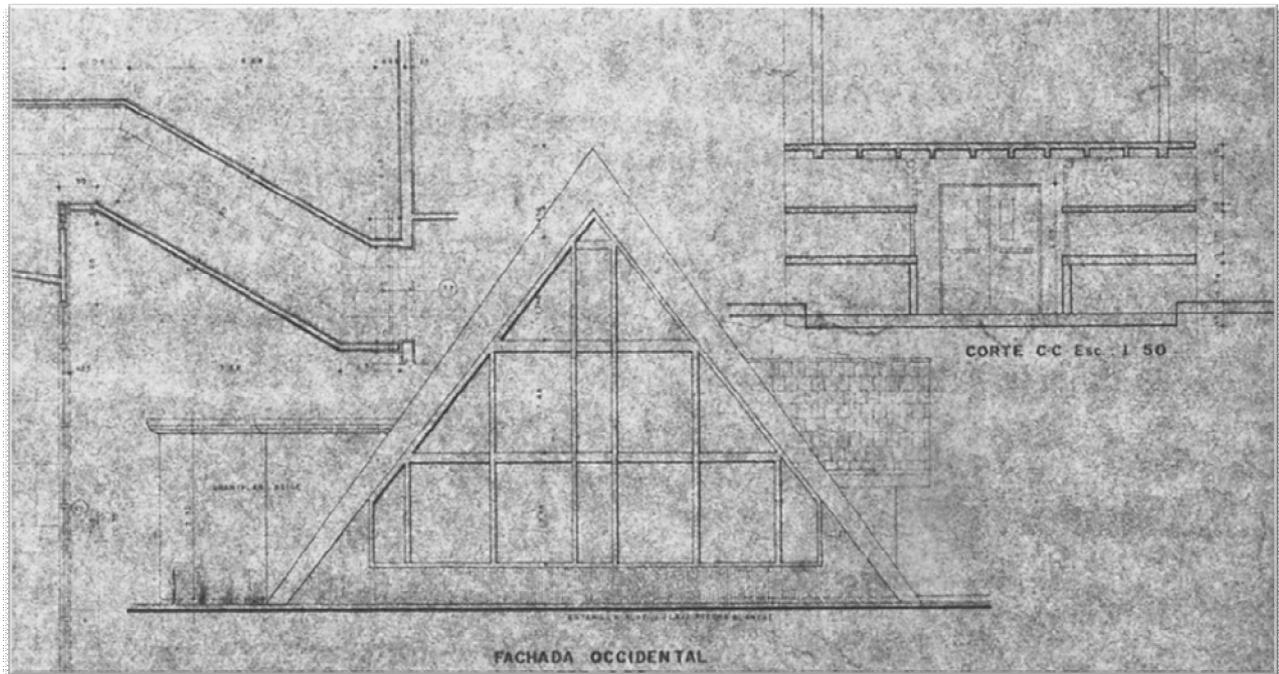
Plano original de la fachada occidental de la capilla. Armando Otálora Castañeda Ingeniero civil, arquitecto Daniel Castillo Sánchez, 1984.
